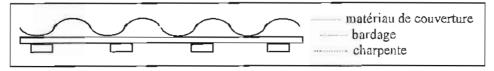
Principe de recouvrement de toiture sur structure porteuse
